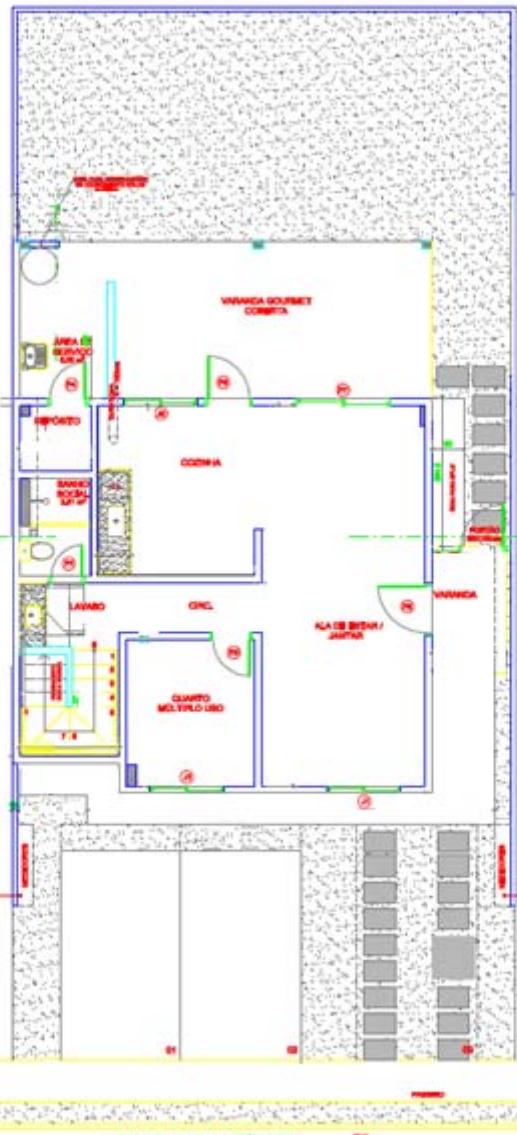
Planta baixa do pavimento térreo da Unidade 2
